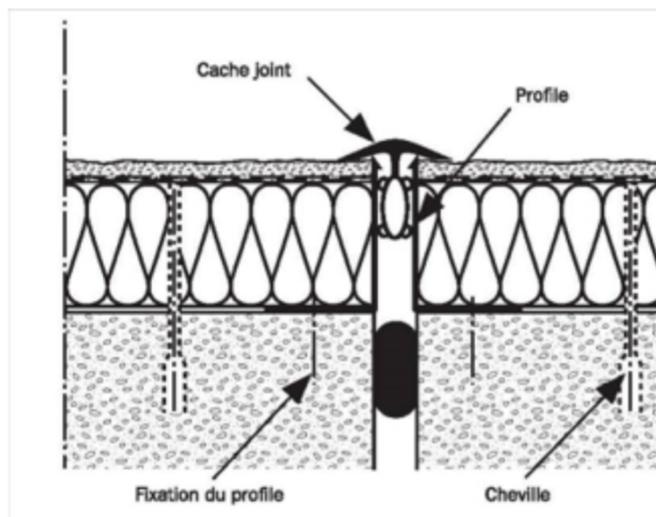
Système fixé mécaniquement par chevilles – Plan de chevillage aux points singuliers
